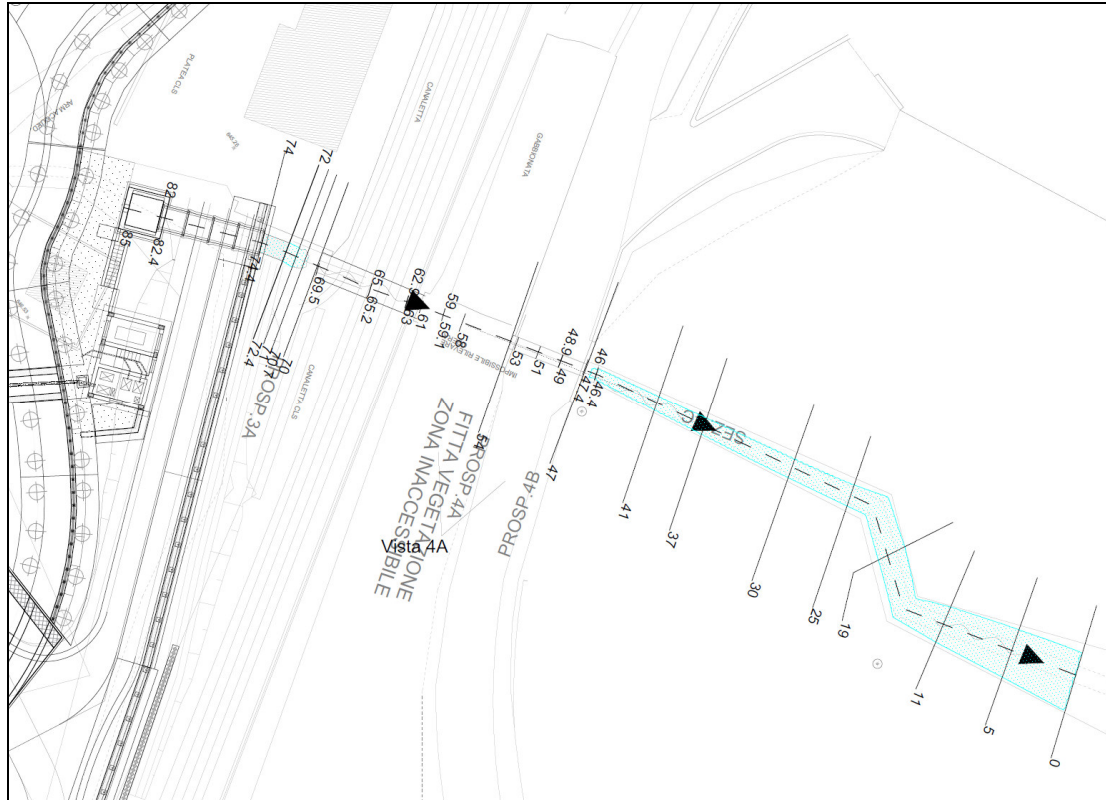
Asse Casello - Planimetria con sezioni di studio post operam
